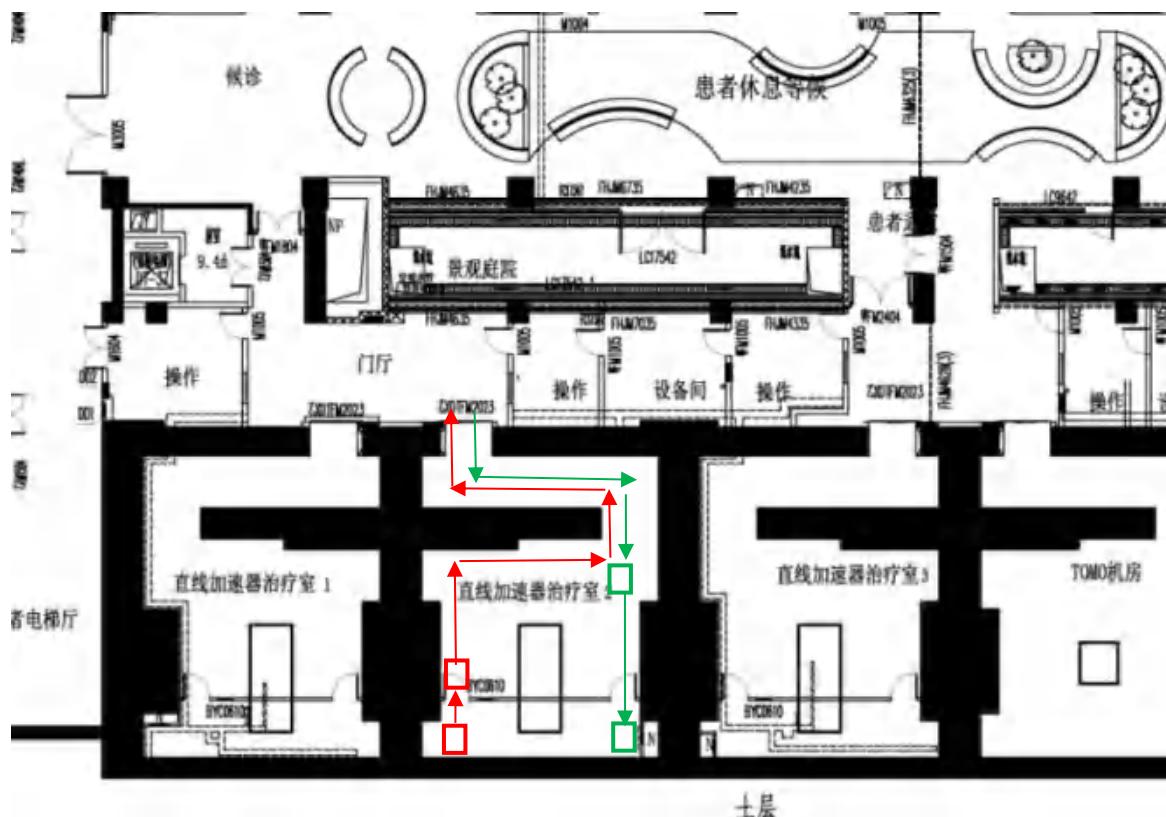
排风管道平面图（注红色为排风、绿色为新风）
